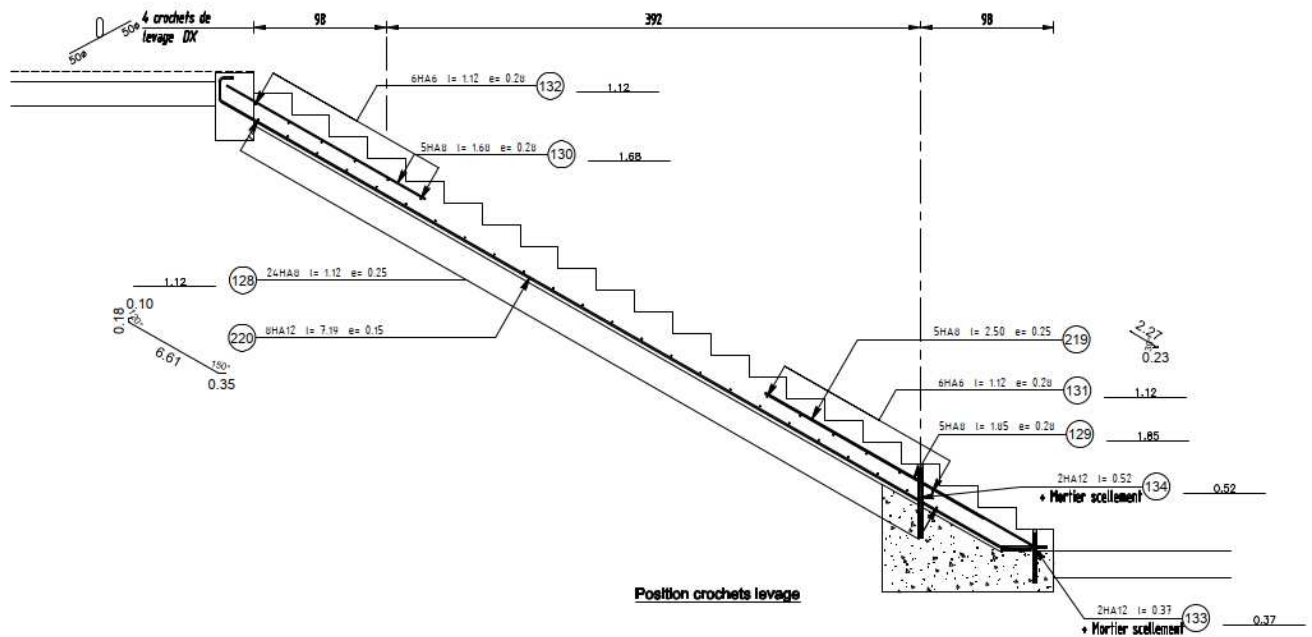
Ferrailage de l'escalier du RDC (vue en coupe)
